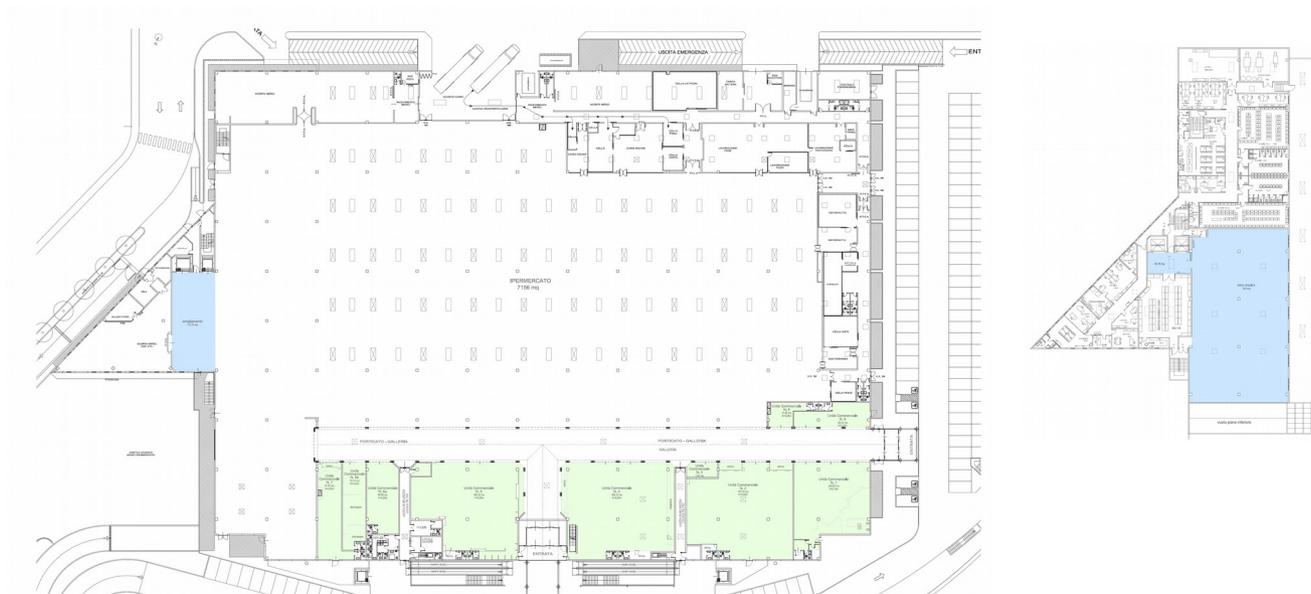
Pianta piano terra e piano primo dello stato di progetto
